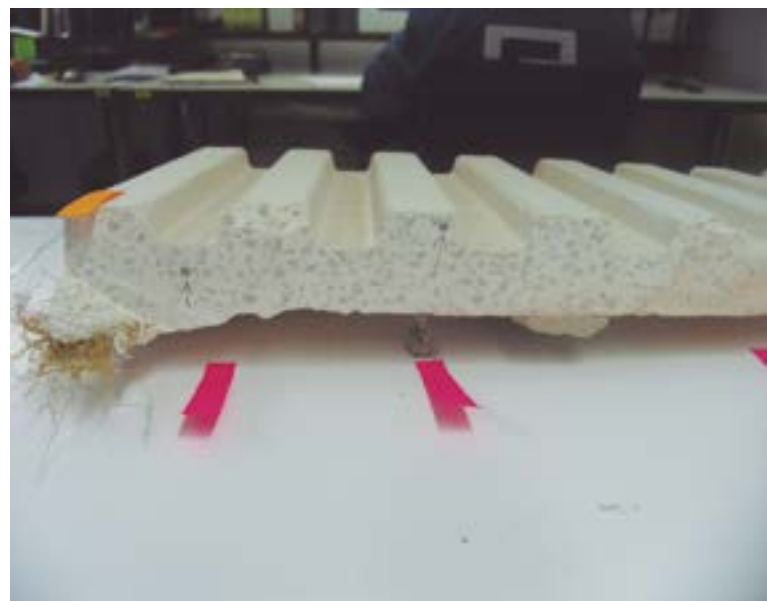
Detalle de muestra de aplacado en objeto de estudio
